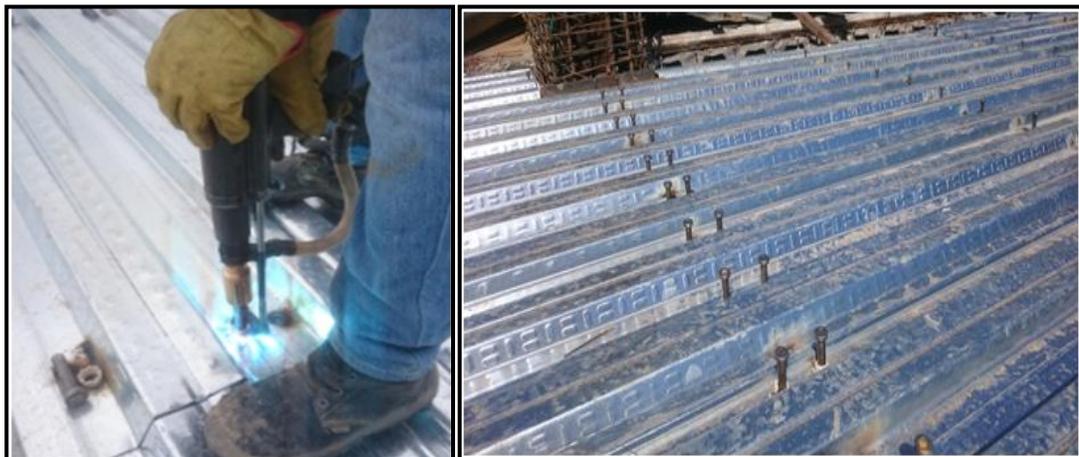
Instalación de conectores de corte. (Fuente: Autoría Propia)
